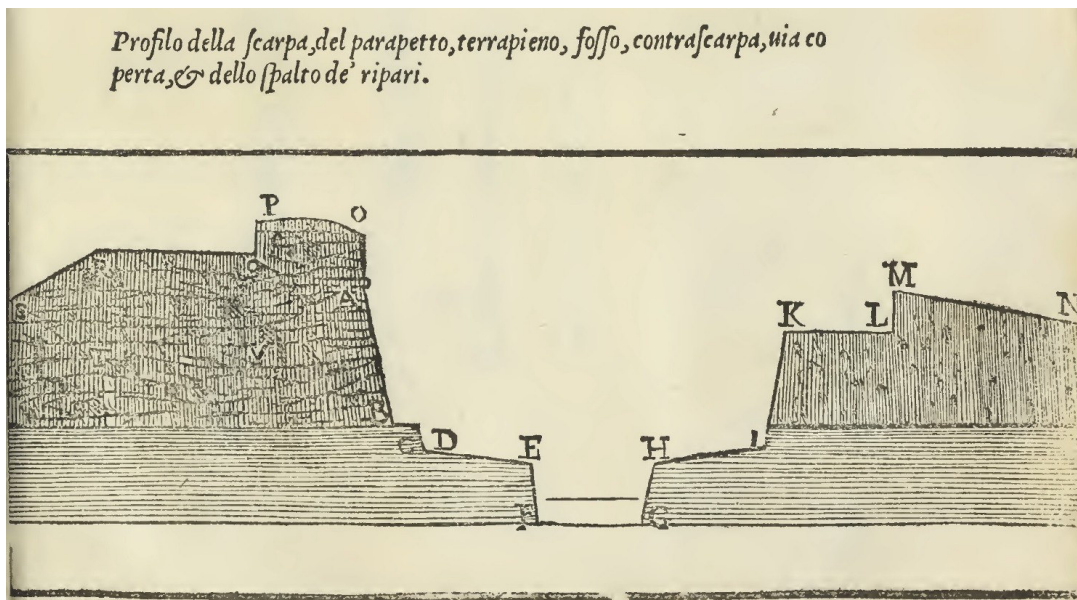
Impresión con "Profilo della scarpa, del parapetto, terrapieno, fosso, contrascarpa, via coperta, & dello spalto de' ripari" ("Perfil de la escarpa, terraplén, foso, contraescarpa, camino cubierto, y de la protección de los refugios") del Tratado de Giovan Battista Zanchi, "Del modo di fortificare le città" ("Del modo de fortificar las ciudades"), 1554
